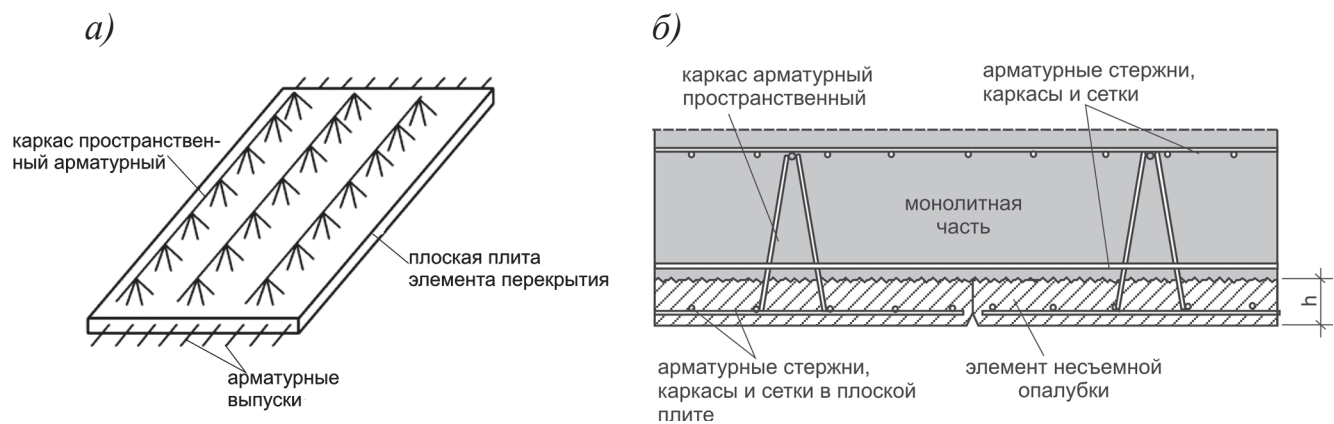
а) элемент несъемной опалубки перекрытия и б) конструкция сборно-монолитного перекрытия
